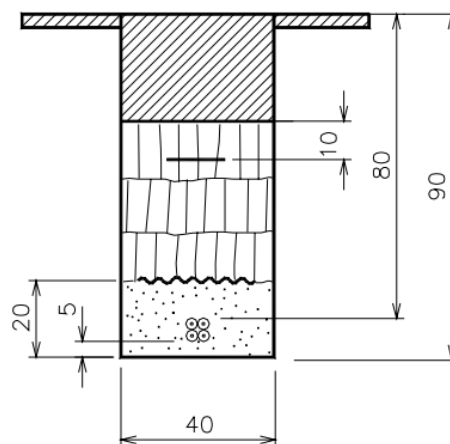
Ejemplo de conductor enterrado bajo calzada
